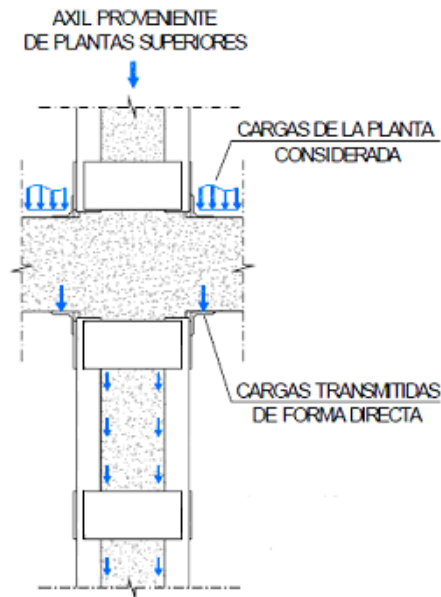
Transmisión directa de tensiones del nudo viga-soporte al refuerzo metálico (Adam, 2007)
